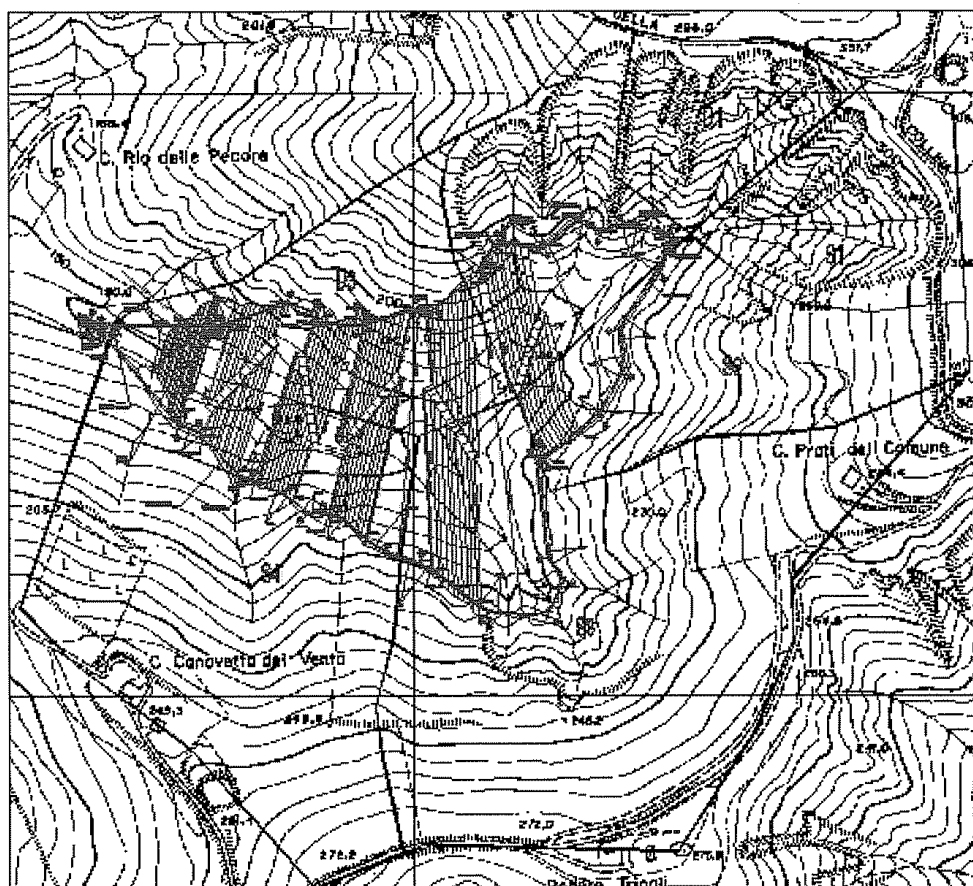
corografia del progetto PREVAM Ca Cirenaica sulla planimetria originaria ante-interventi
